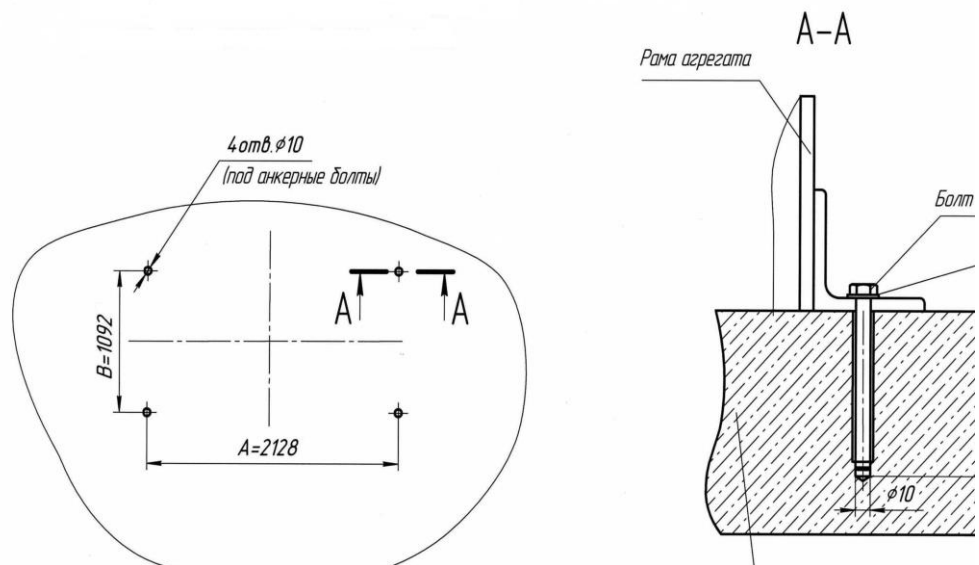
Схема монтажу анкерних болтів у бетонну основу
